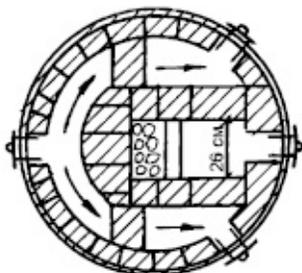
Кладка отопительной круглой печи в металлическом футляре
